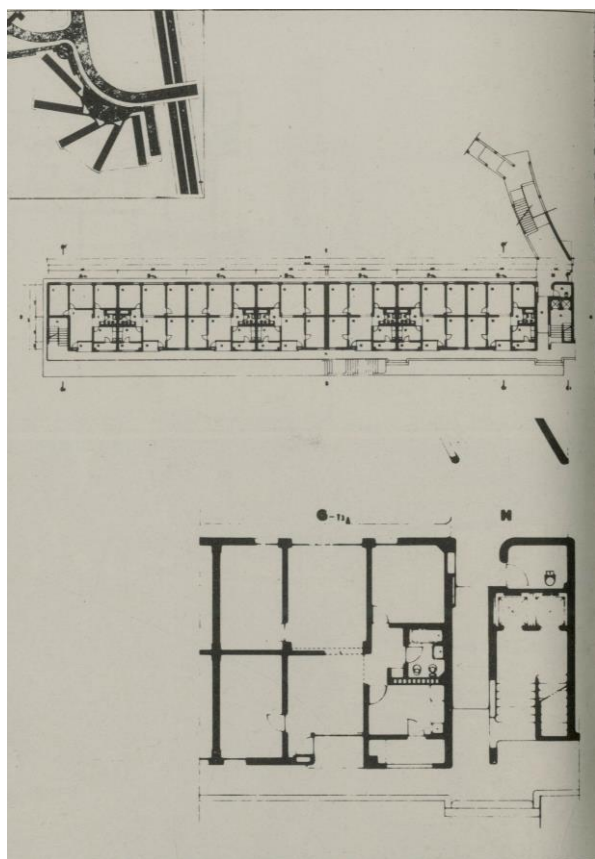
Planta de um piso tipo e do interior de um fogo.
